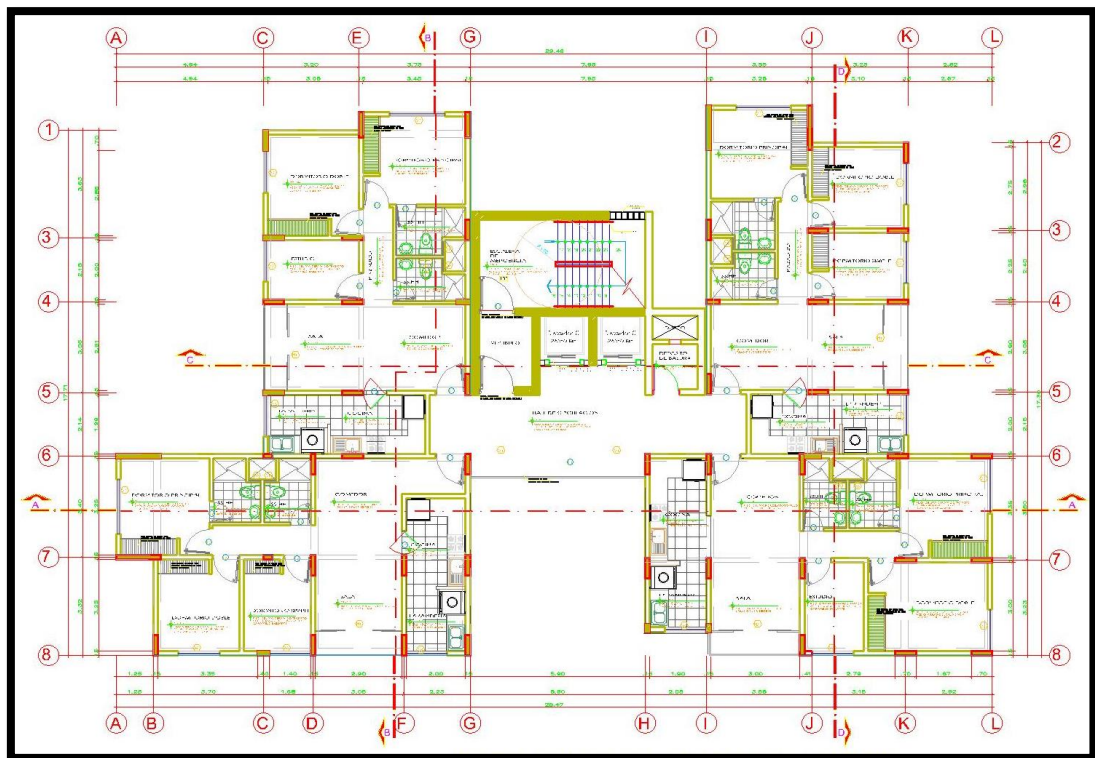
Diseño Plano Segundo Nivel – Planta Típica
